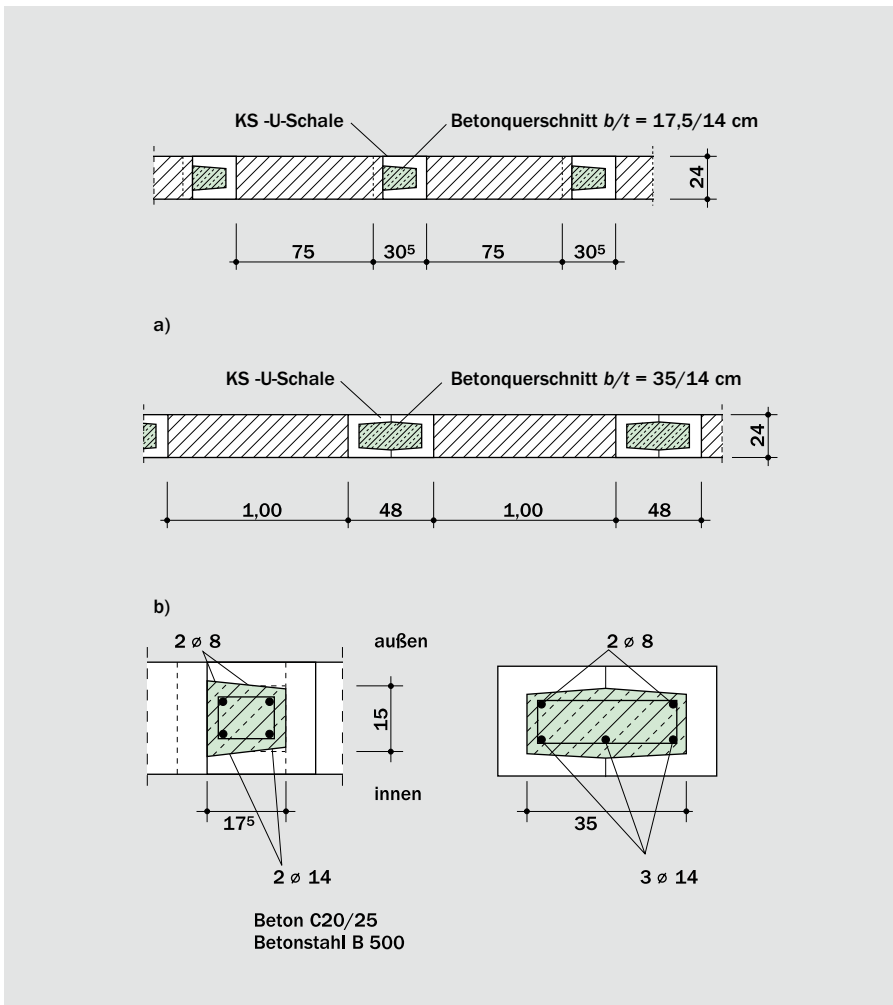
Aussteifende Stahlbetonstützen unter Verwendung von KS -U-Schalen
